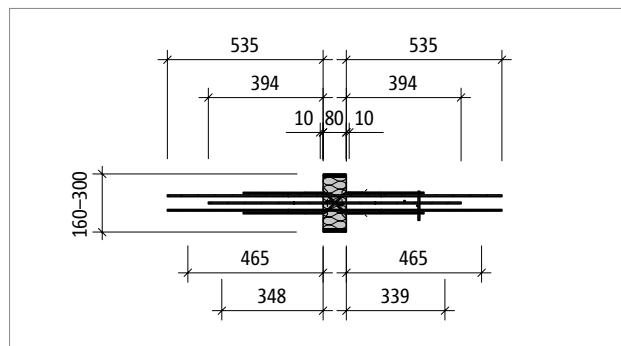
Schöck Isokorb® T Typ WL-M1: Produktgrundriss
